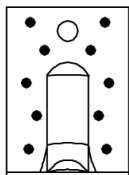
Przekroje fragmentu konstrukcji stropu drewnianego
